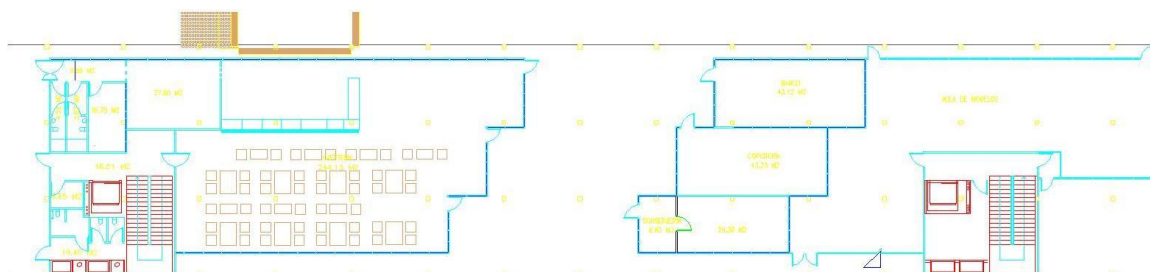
instalaciones de la planta baja del edificio nuevo de Antigones
